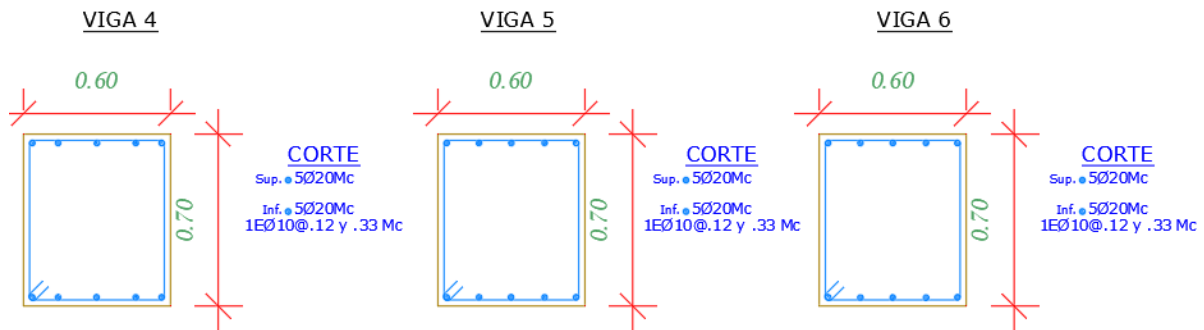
Secciones transversales de las vigas utilizadas en un edificio de 6 pisos.
